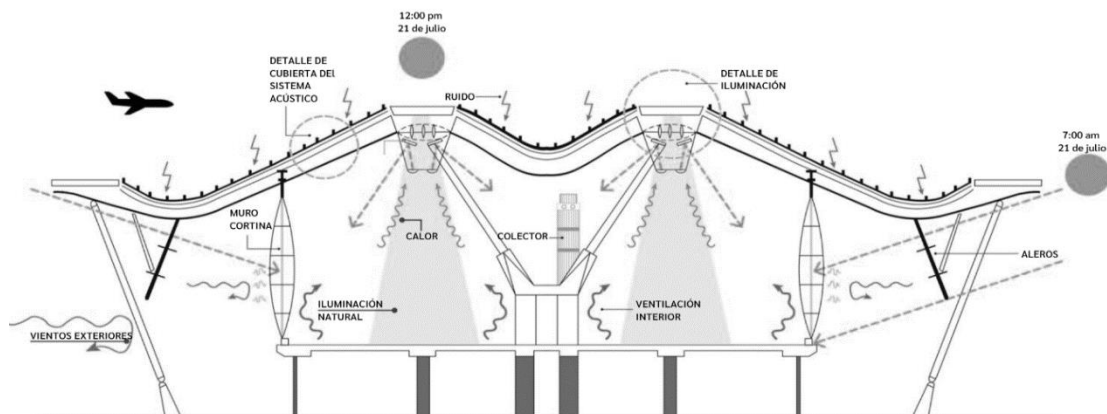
Detalle fachada principal del aeropuerto de Zaragoza
